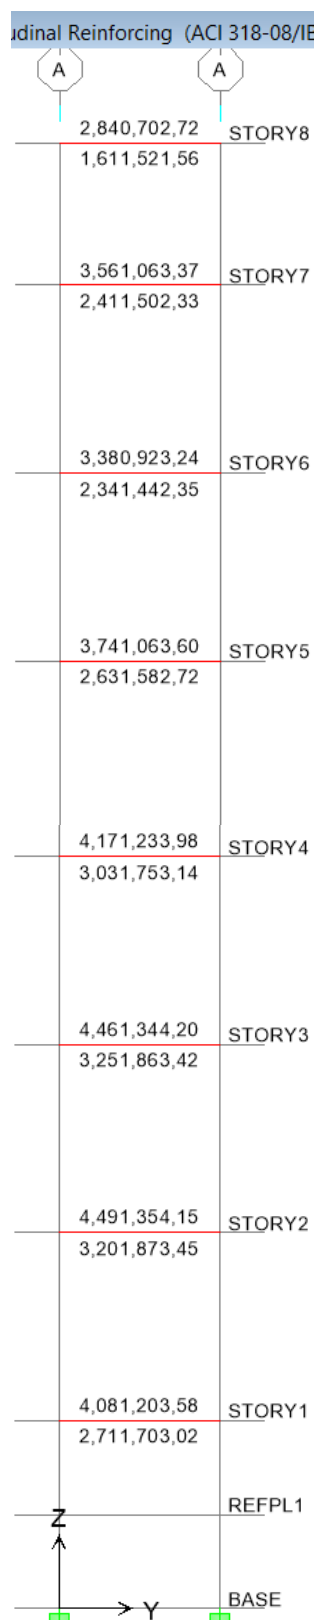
Acero en Vigas y Columnas en el Pórtico A – Escalera Emergencia Hospitalización 2- (CEC-2002)
